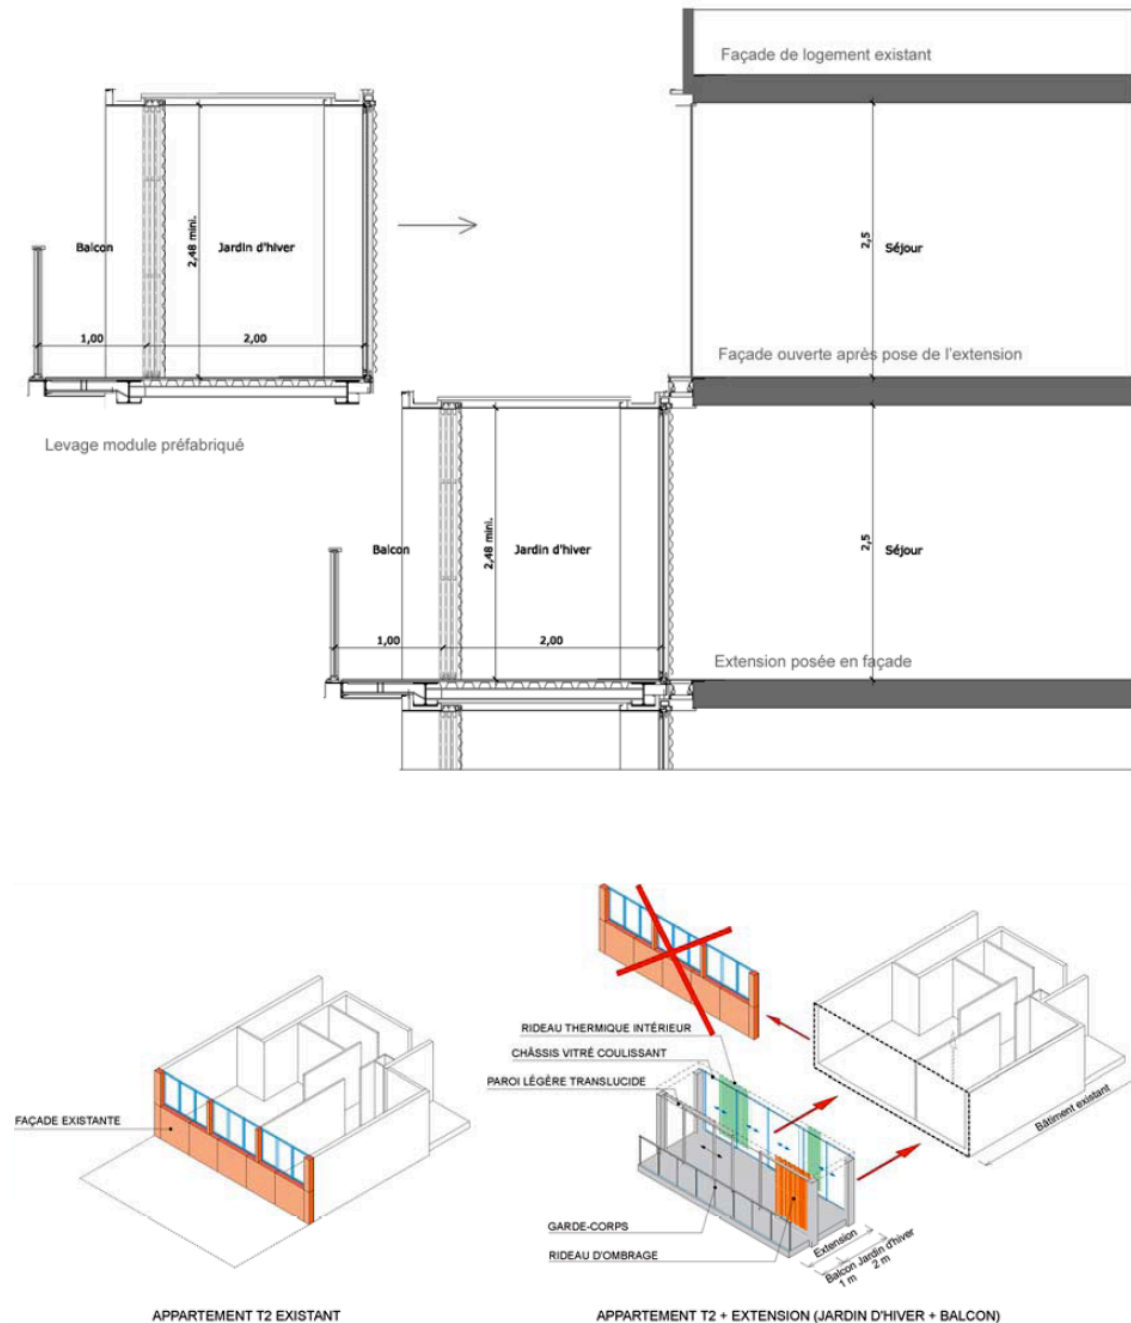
Sección constructiva que muestra la instalación del módulo prefabricado de extensión de las viviendas en el proyecto de reciclaje de la torre en la avenida Bois Le Prêtre. Los módulos se ensamblan entre sí, y a su vez son conectados a una estructura autoportante de acero laminado, anexa a la fachada original de la torre, y enlazada a los cantos de los forjados para aportar estabilidad necesaria dada su esbeltez. Fuente: estudios de arquitectura de Lacaton@Vassal y Frédéric Druot.
